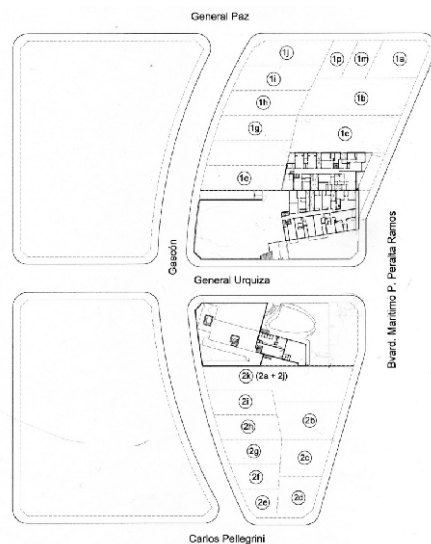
Planta de conjunto manzanas 1e86a, b, c y d
